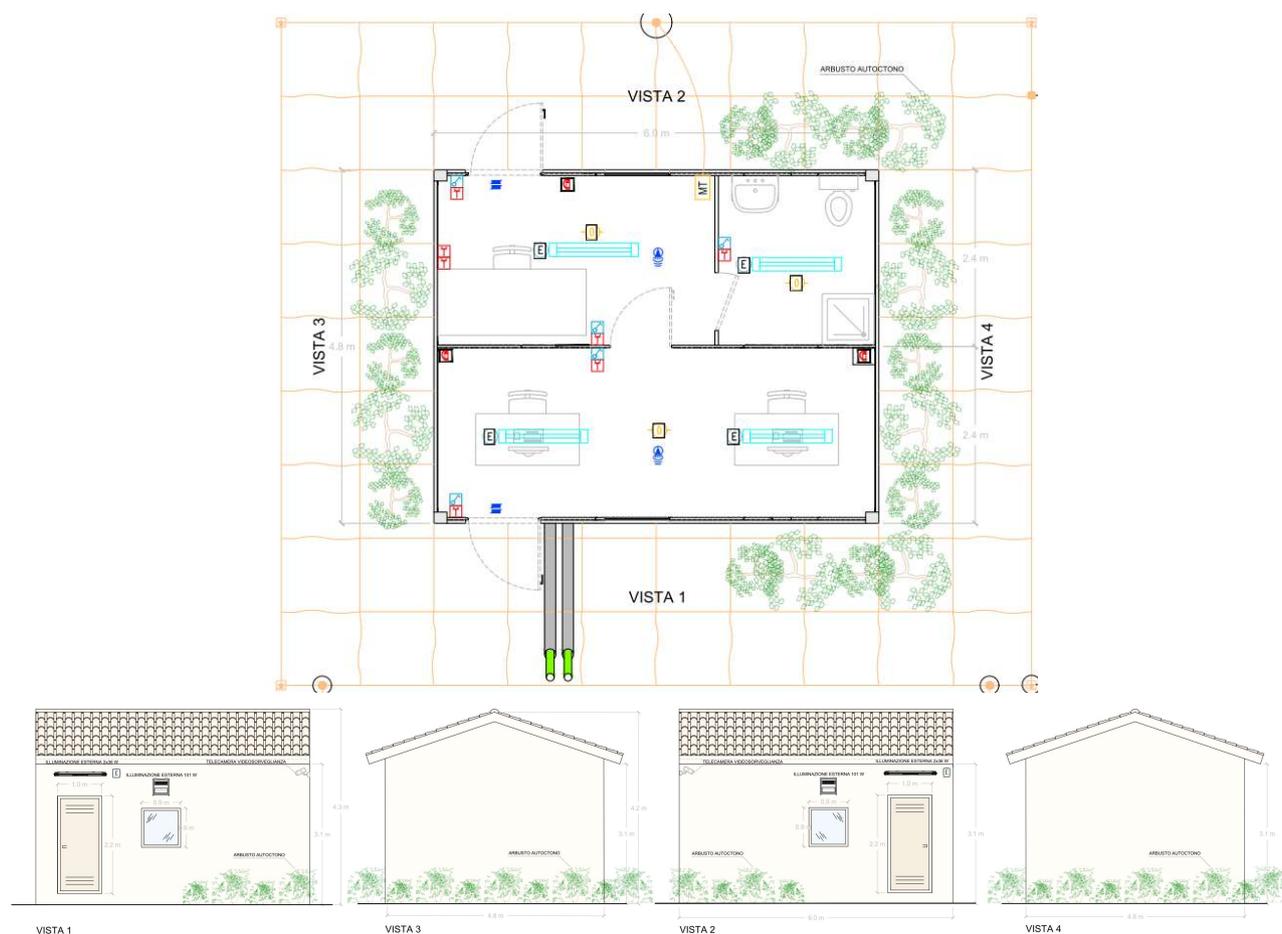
Planimetria e prospetti Cabina ufficio
